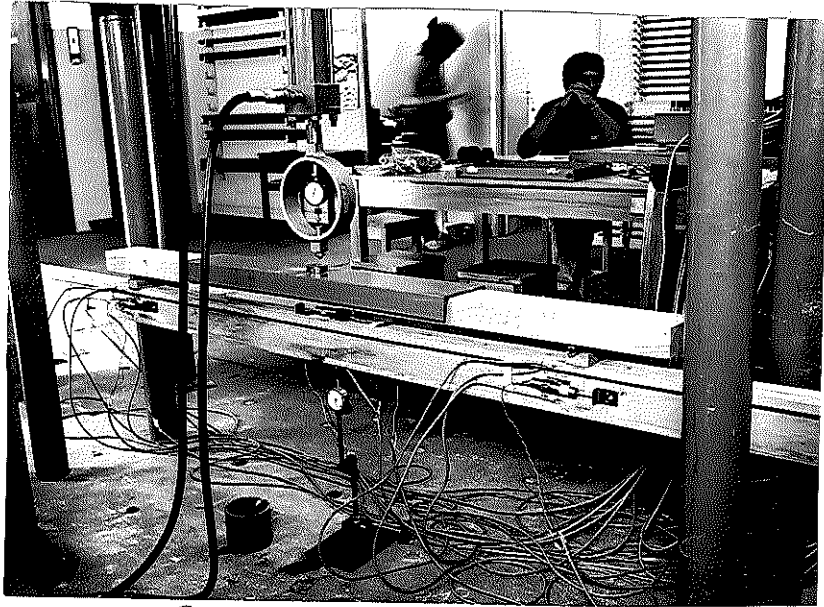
VISTA GERAL DO ENSAIO DA VIGA PROTENDIDA - CABO RETO
